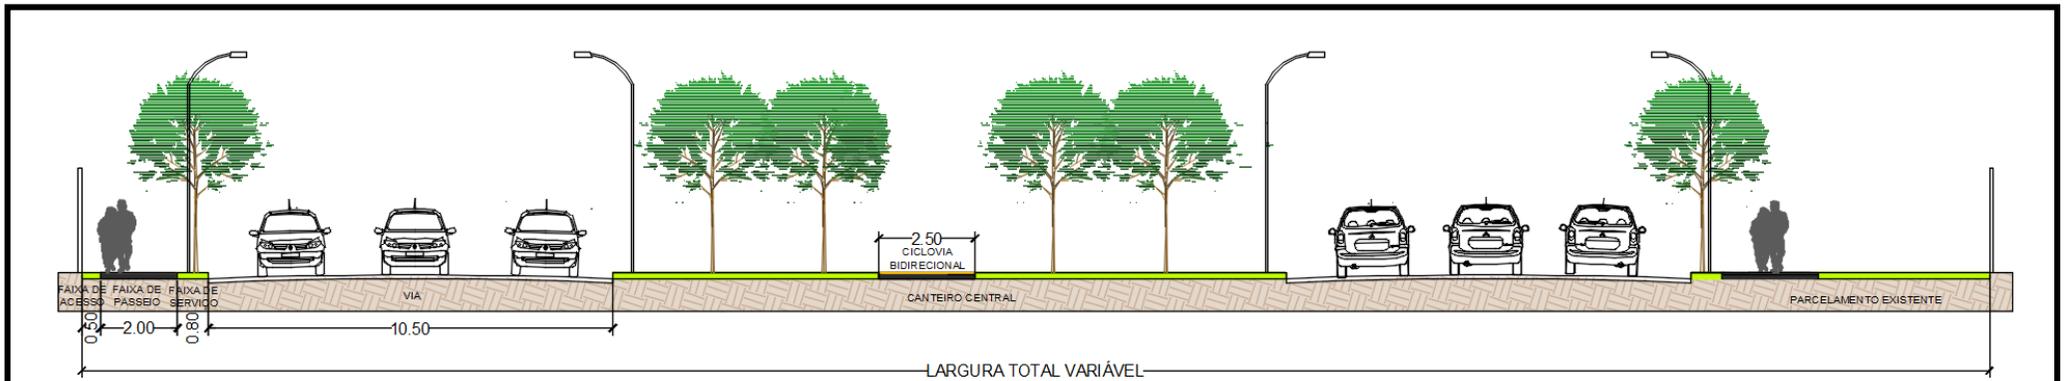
Perfil da Via de Circulação – Perfil 03 - Perpendicular a BR-070 (via existente) (Fonte: Própria)
